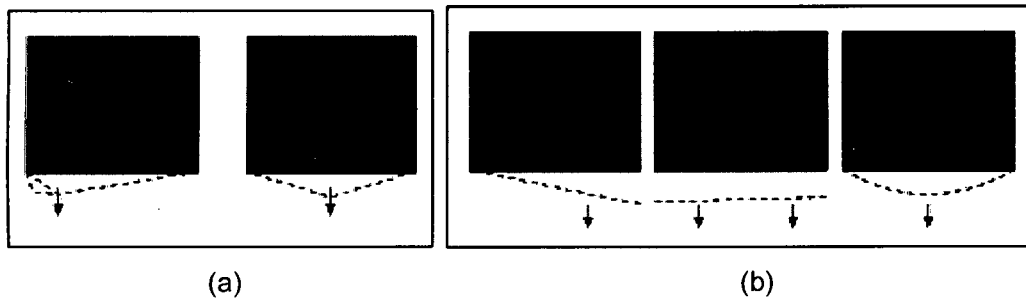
(a) fisuras en muros debido a un asentamiento puntual en la cimentación. (b) fisuras en muros debido a un asentamiento uniforme en la cimentación (Broto, 2004).
